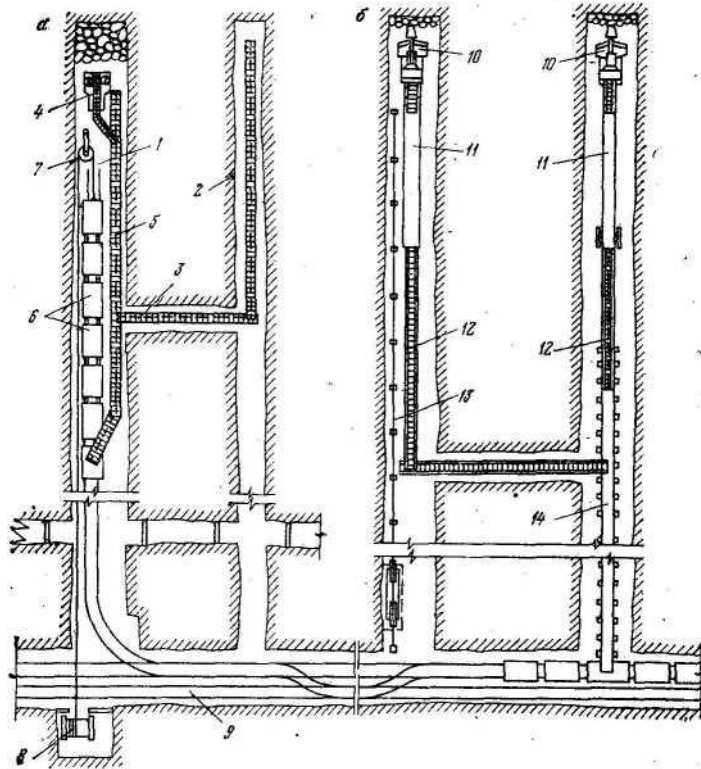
Схеми будівництва Бремсберга і ходка
